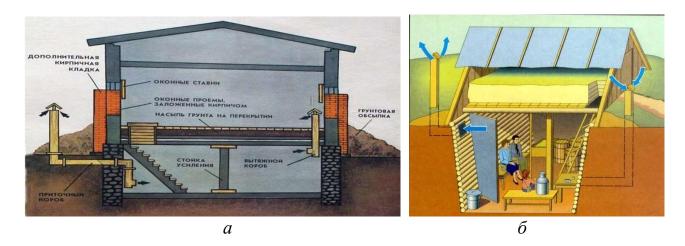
Оборудование подвального помещения (а) и погреба (б) под ПРУ
